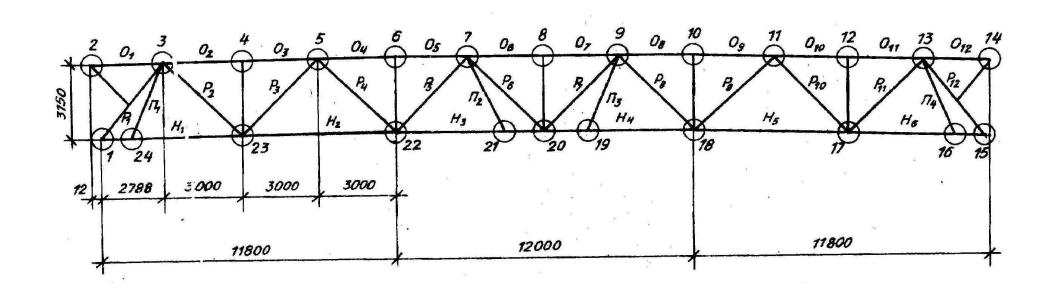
Геометрическая схема фермы V Φ C-36-1, 85 В
